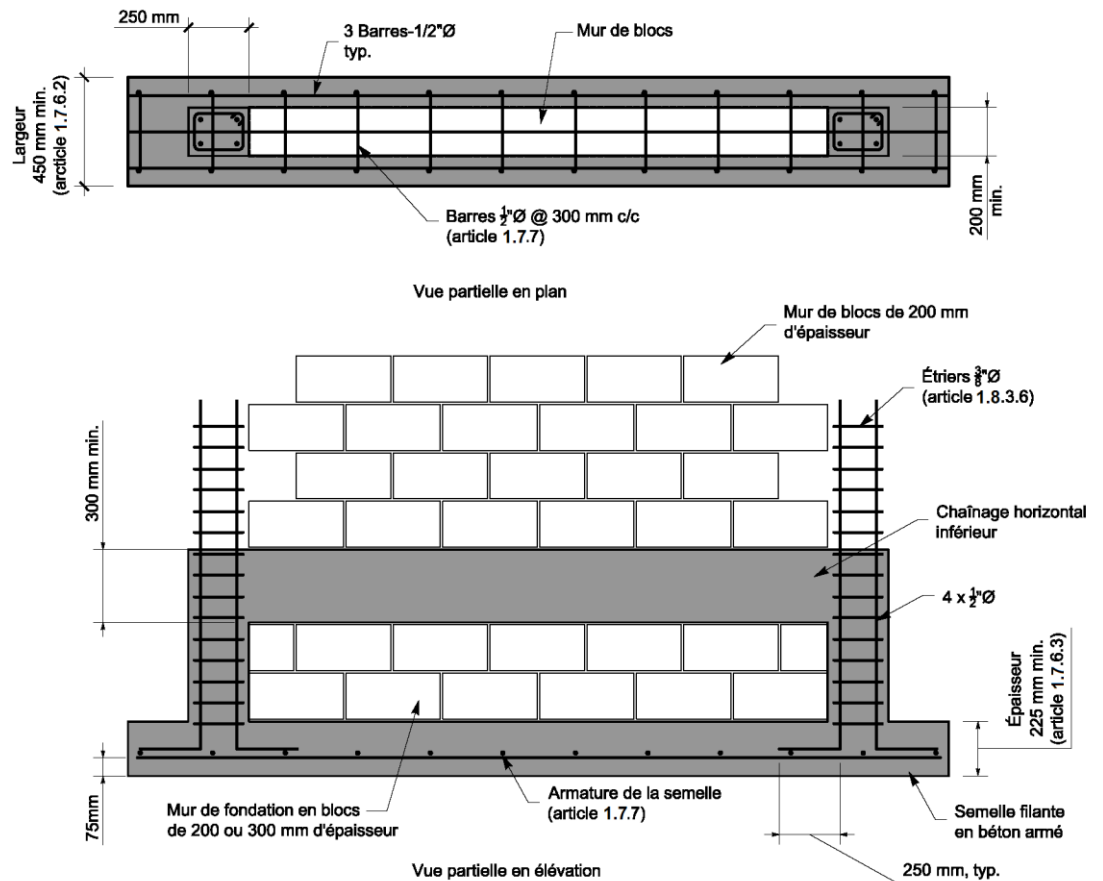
Ancrage des chaînages verticaux à la semelle de fondation
